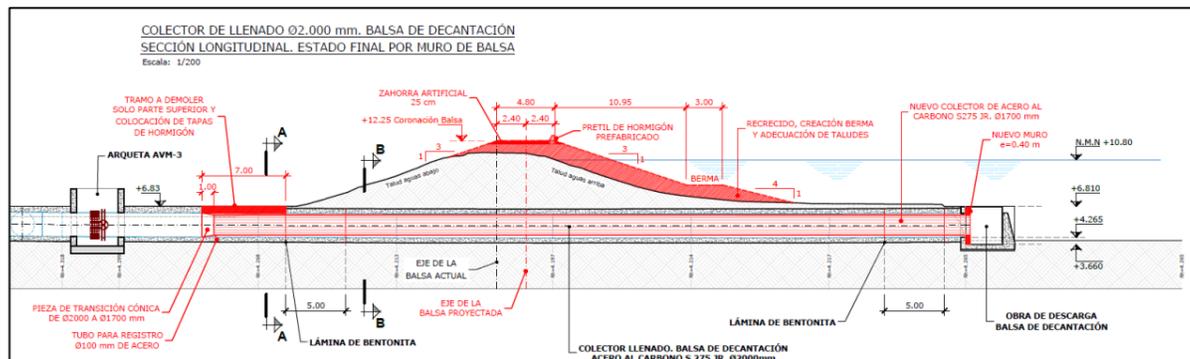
Perfil longitudinal de colector de llenado de balsa de Decantación. Balsa Belmonte
